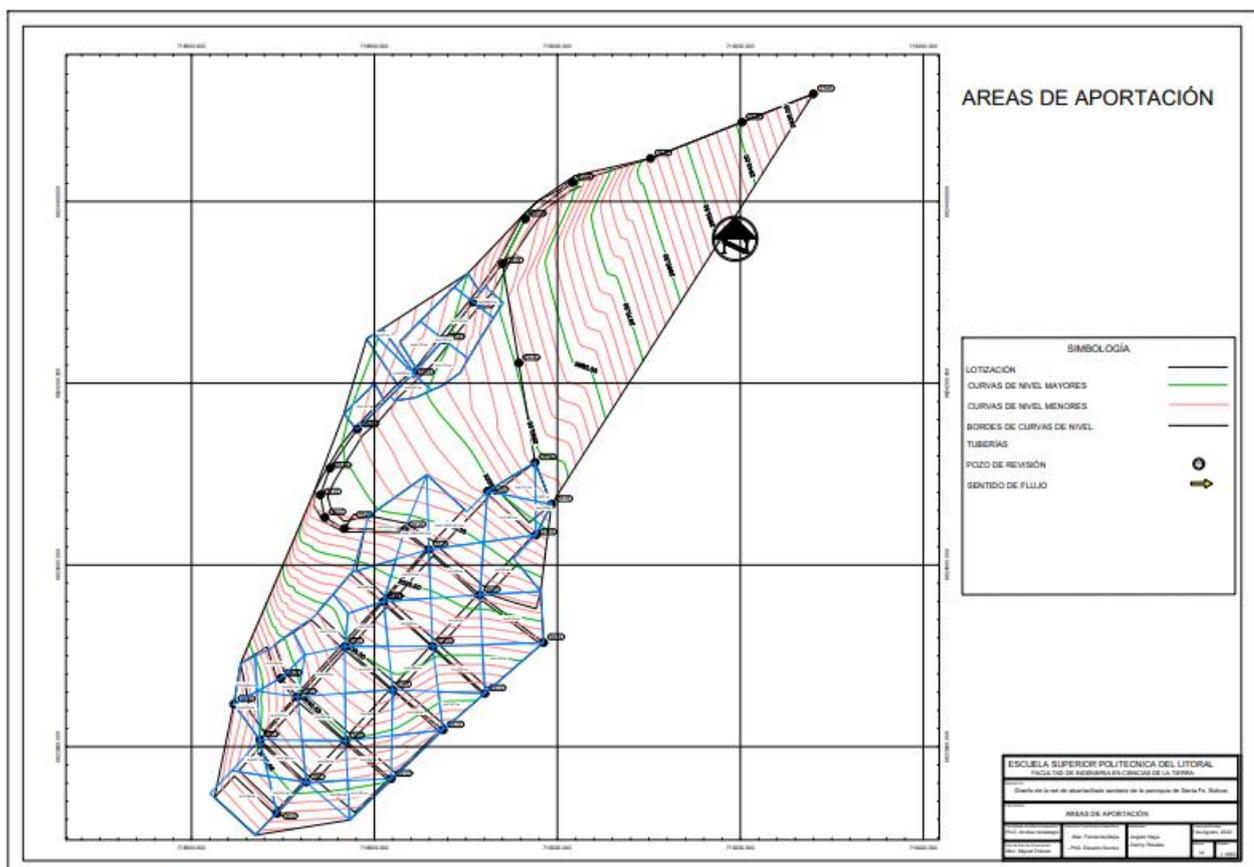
Áreas de aportación para red de alcantarillado sanitario de Santa Fé
